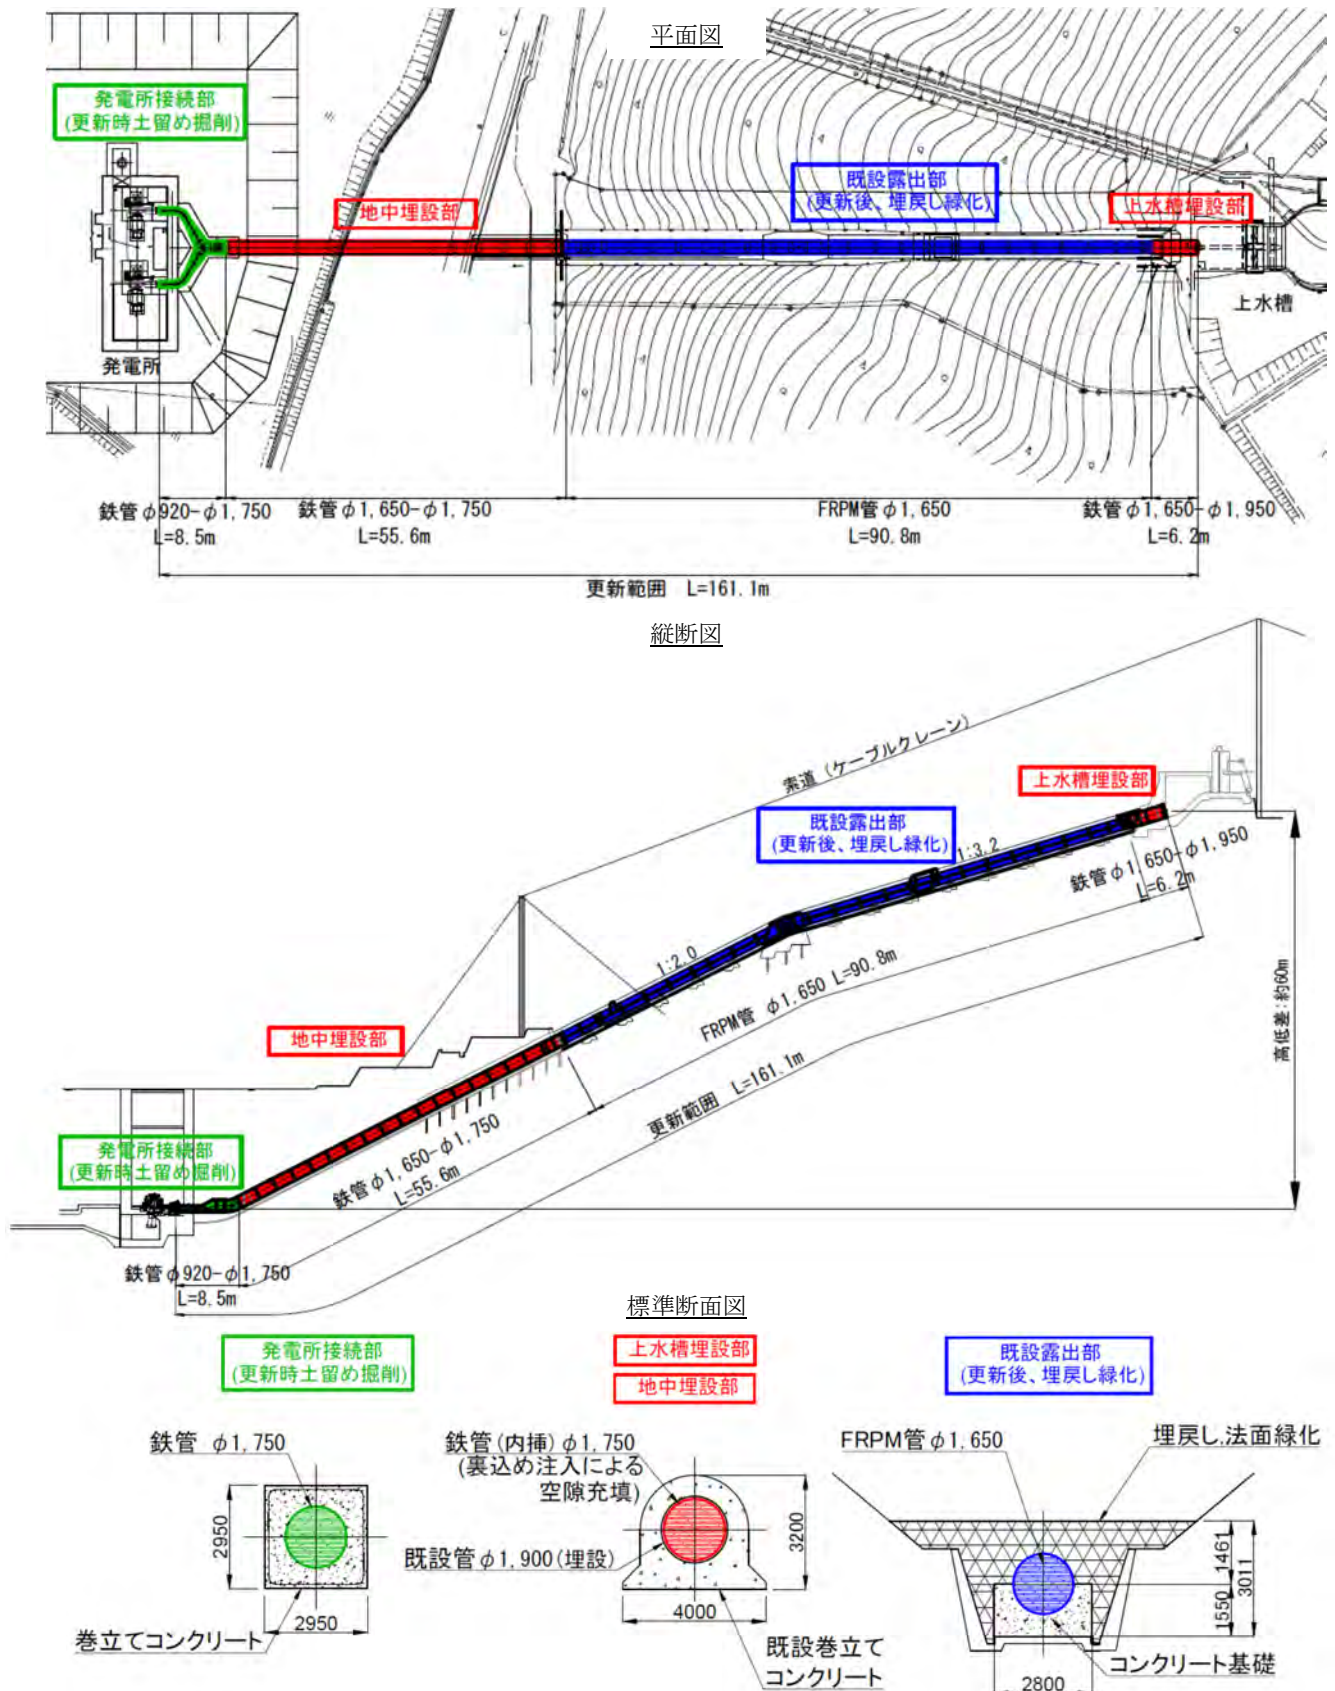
更新完了時の水圧管路(平面図・縦断面図・標準断面図)
